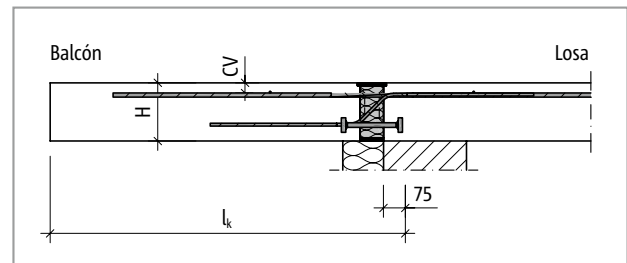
Schöck Isokorb® T tipo K-M12: Sistema estático
